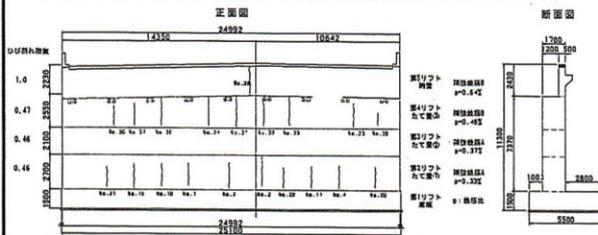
補強鉄筋を配置してひび割れを分散させた幅25mの橋台
